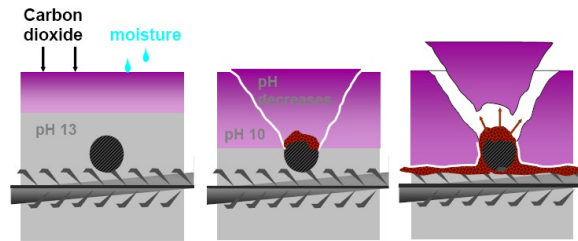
Ilustración del proceso de afectación de las estructuras de Hormigón Armado
